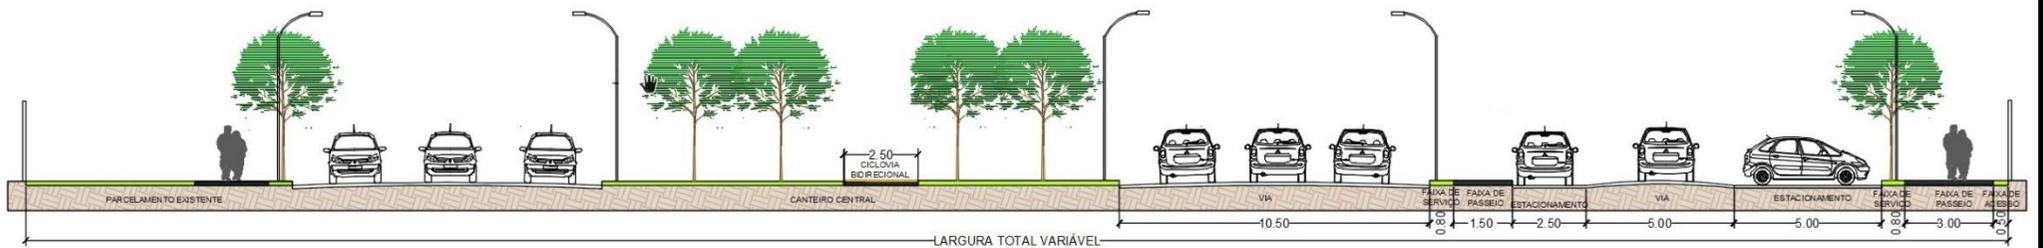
Perfil da Via de Atividades – Perfil 02 – Perpendicular a BR-070 (via existente) (Fonte: Própria)
